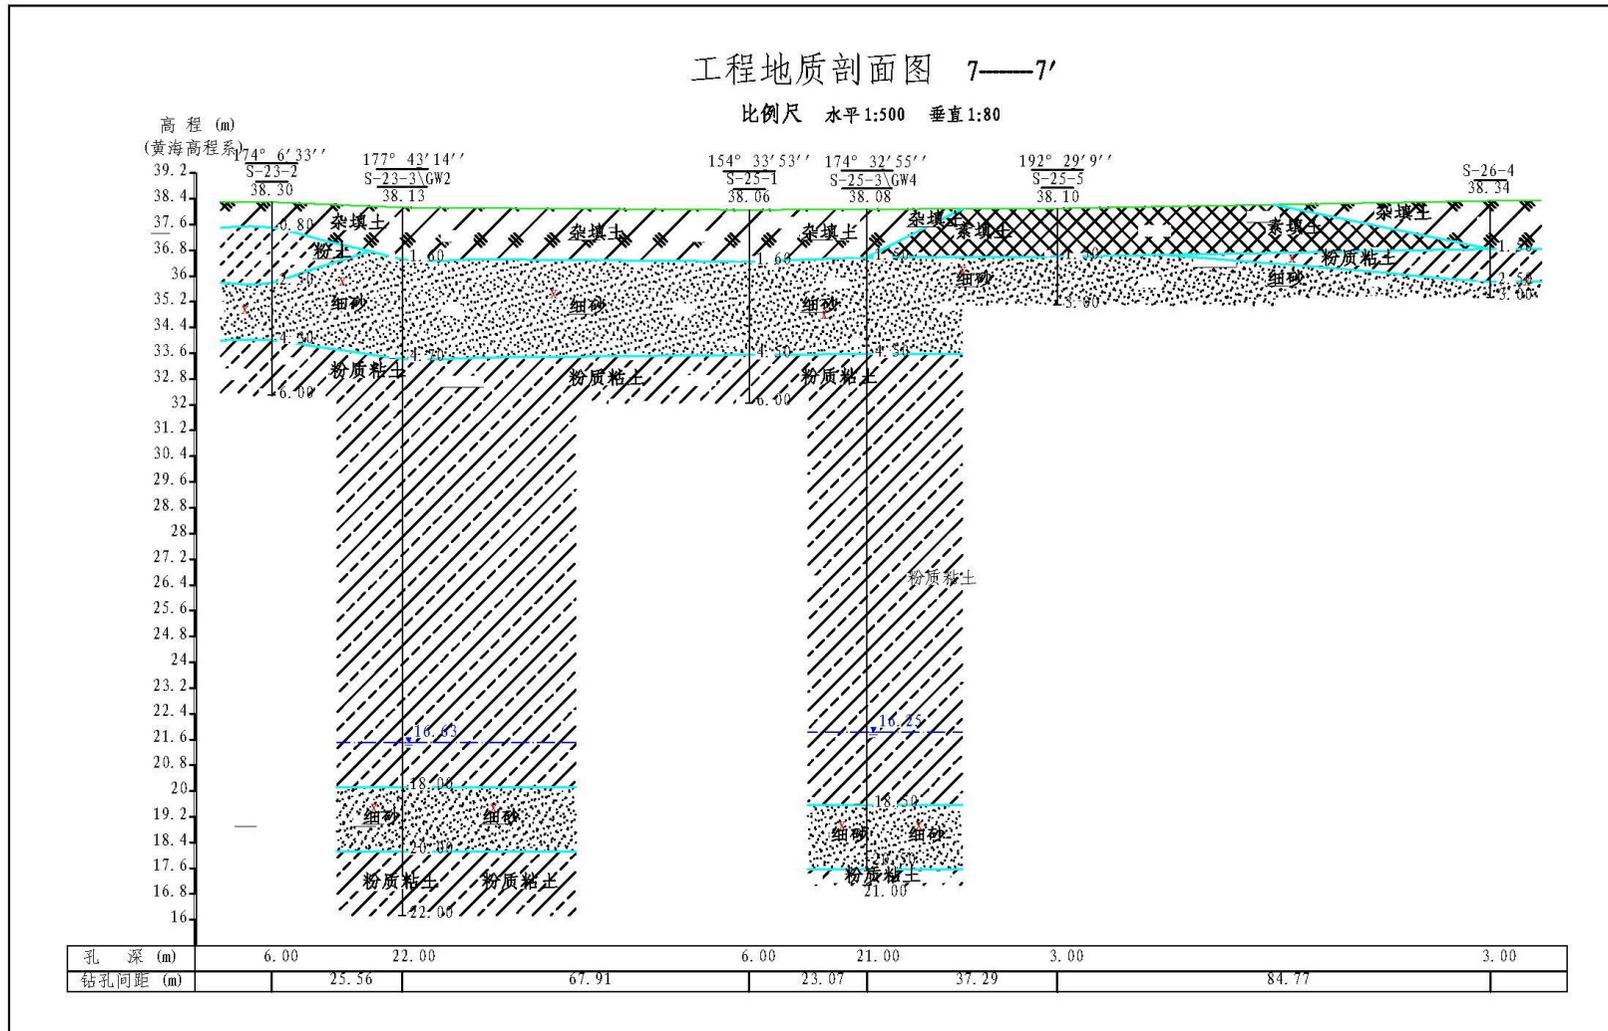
剖面线 7-7'地质剖面图 (纵向)
